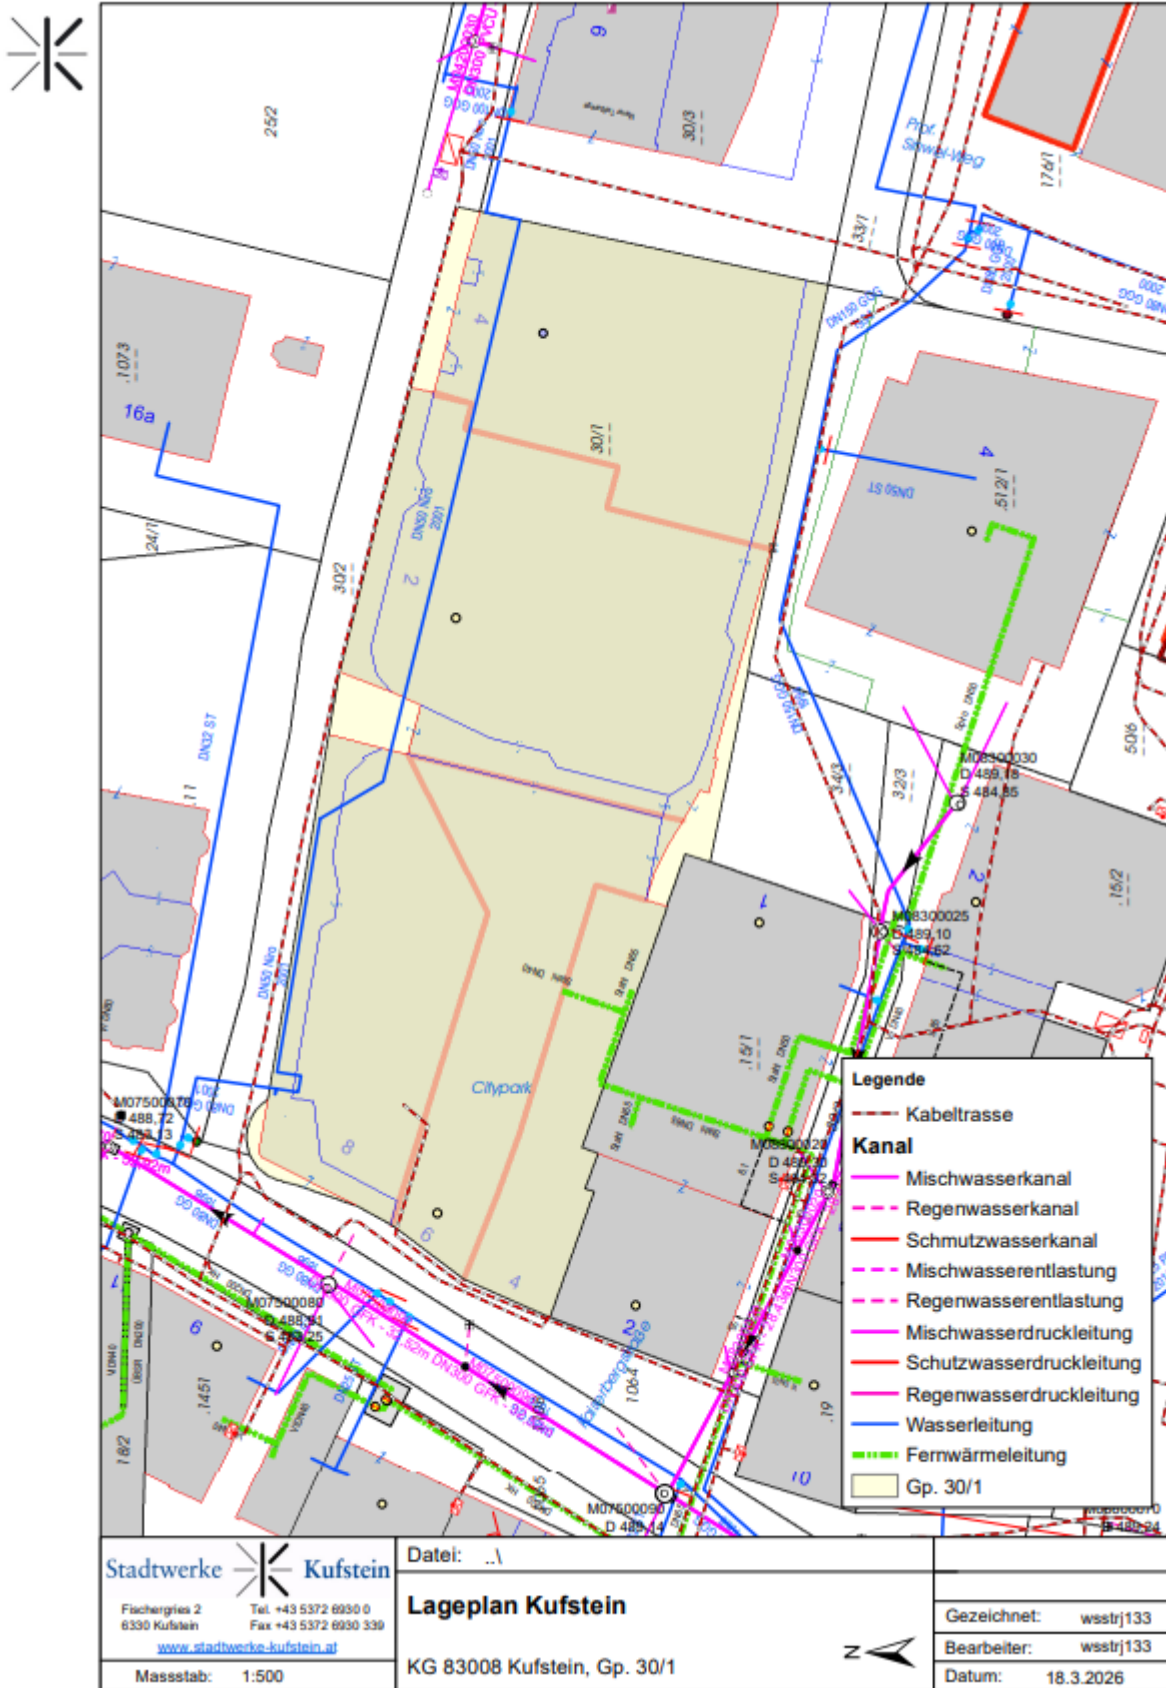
Leitungsplan (Stadtwerke Kufstein, v. 18.03.2026)
